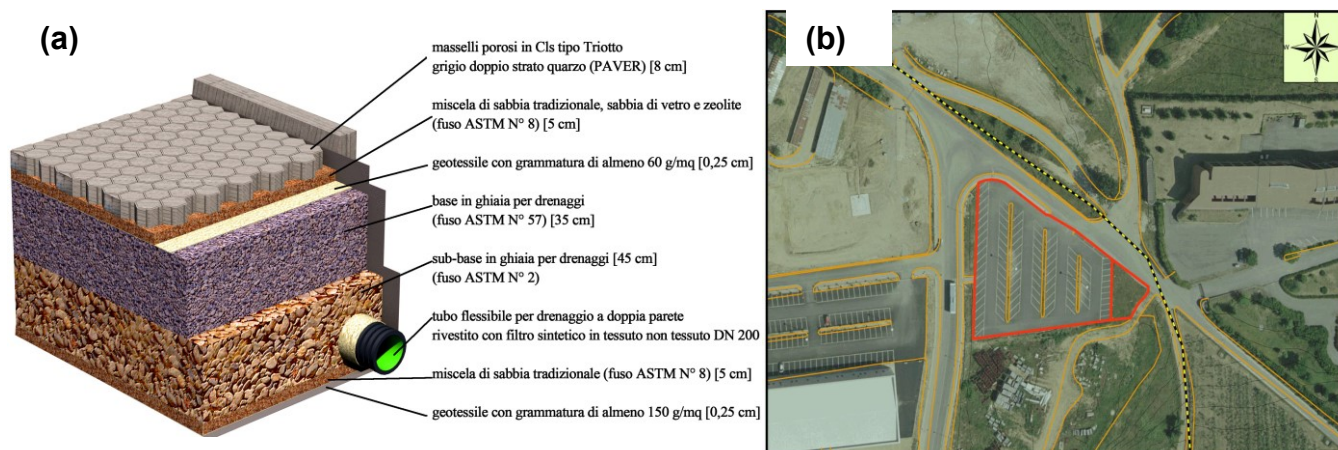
Descrizione del sito sperimentale: nel pannello (a) è riportata la stratigrafia della pavimentazione drenante, il pannello (b) illustra invece la posizione planimetrica della stessa installazione sperimentale (Piro ed. 2015).
